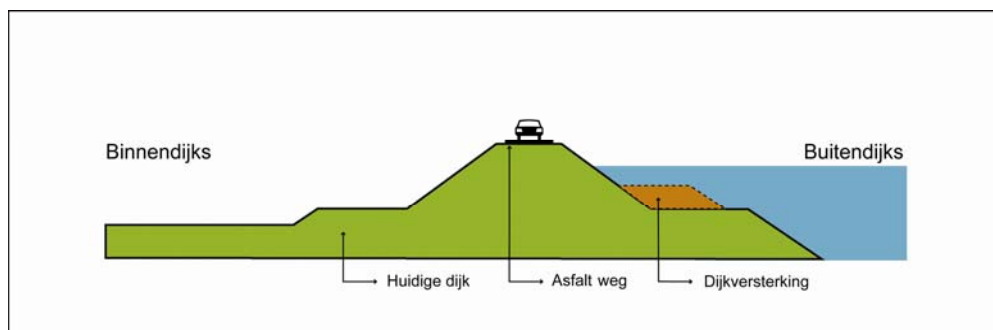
Het ingraven van klei vermindert de doorstroomcapaciteit niet
